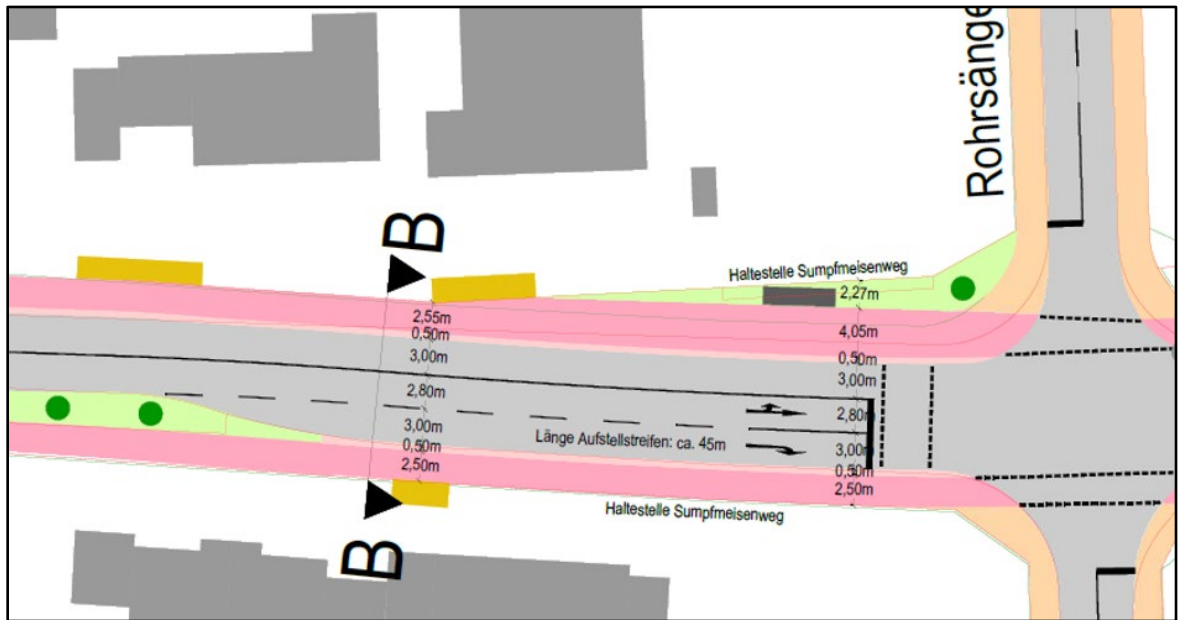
Lageplanausschnitt westlich Sumpfmosenweg (Quelle: INOVAPLAN GmbH)
